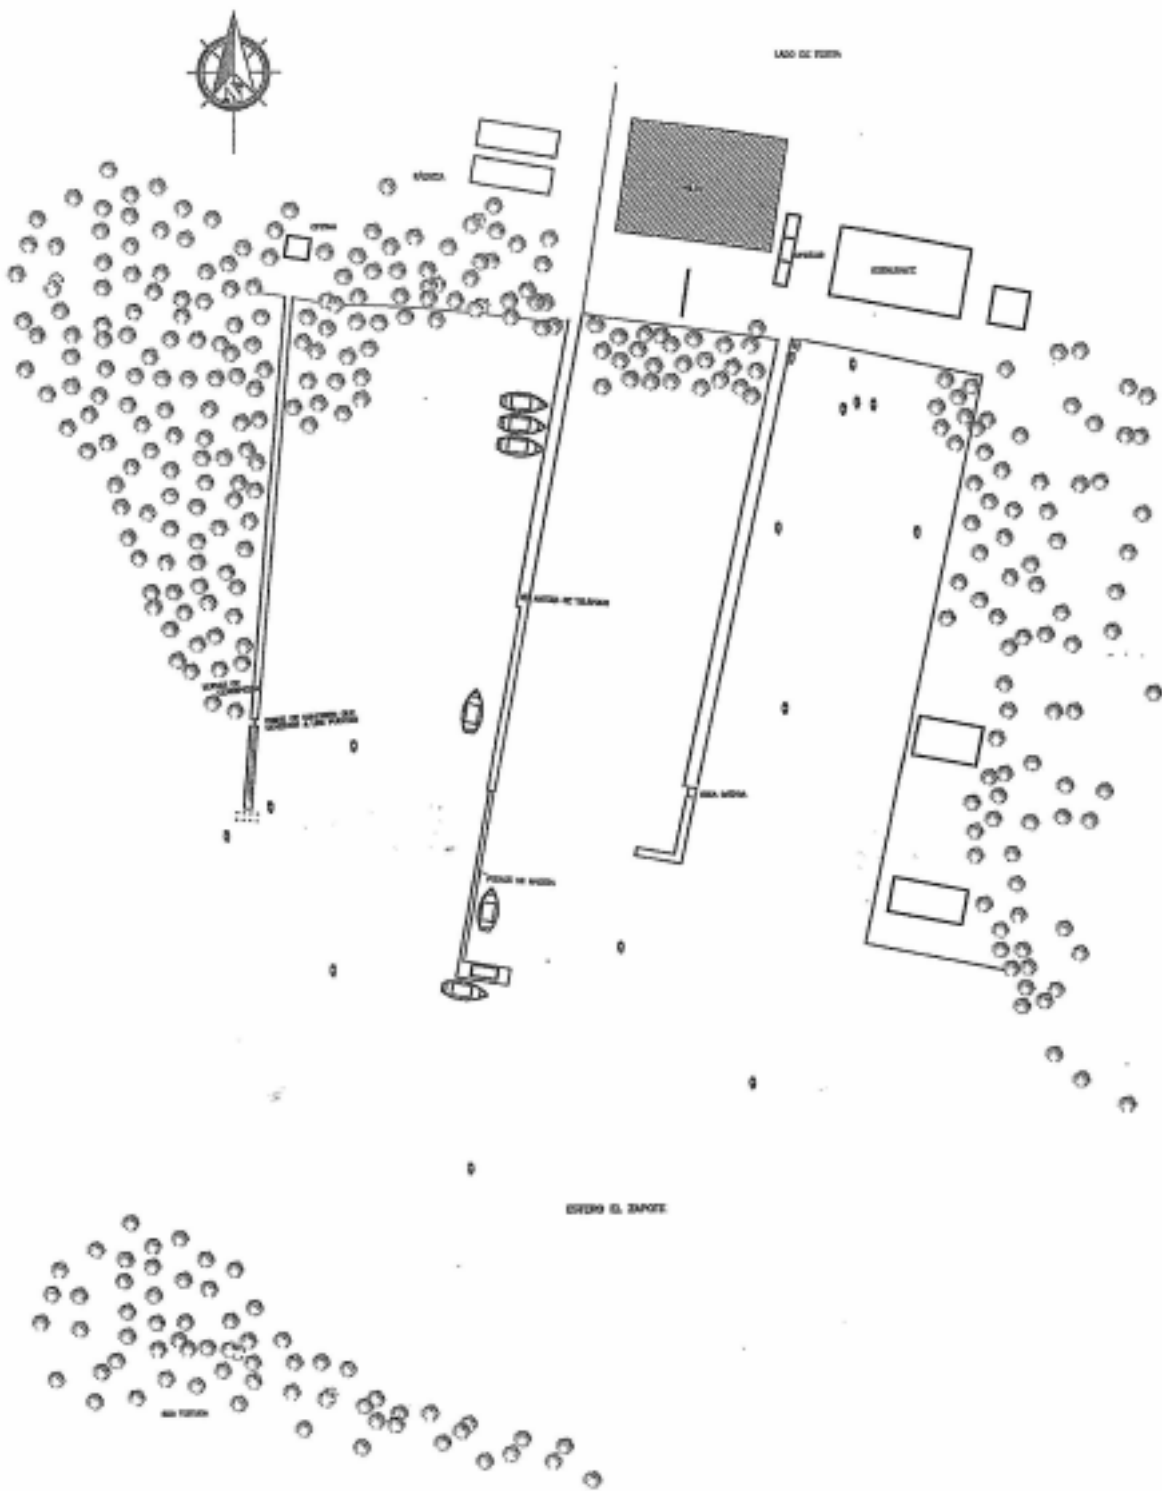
プエルト・エル・トゥリウンフォ漁港の概略平面図
